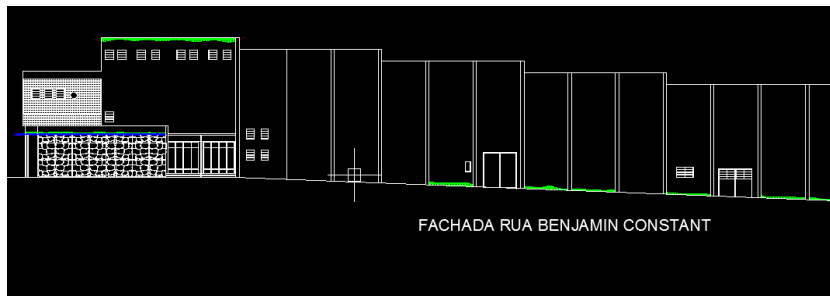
imagem da fachada lateral do prédio na face Sul Rua Benjamin Constant.
